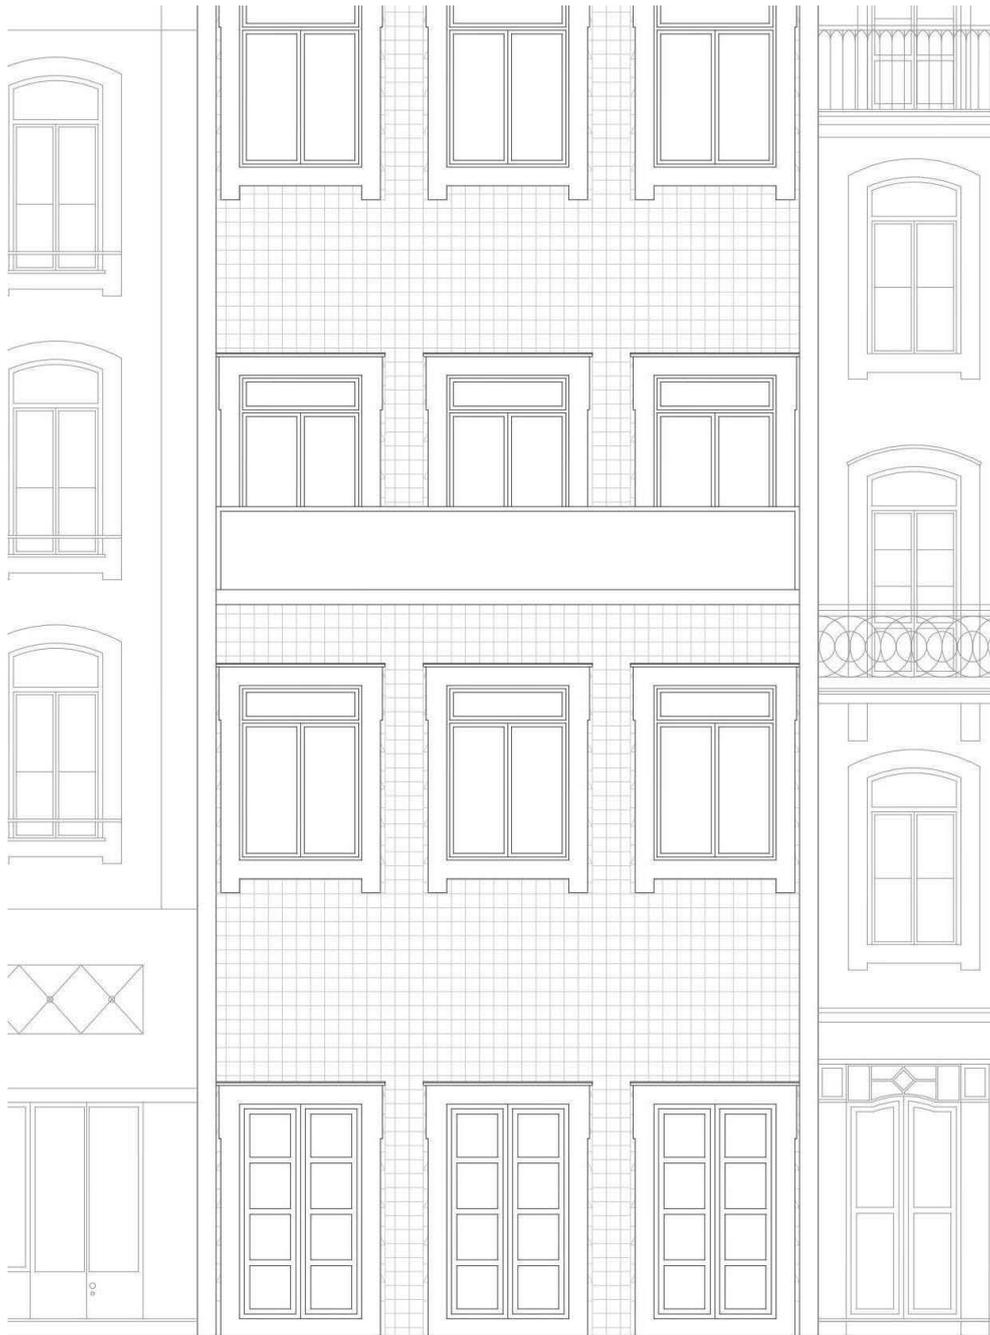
Fachada do prédio d'A Brasileira, anterior a 1921.
